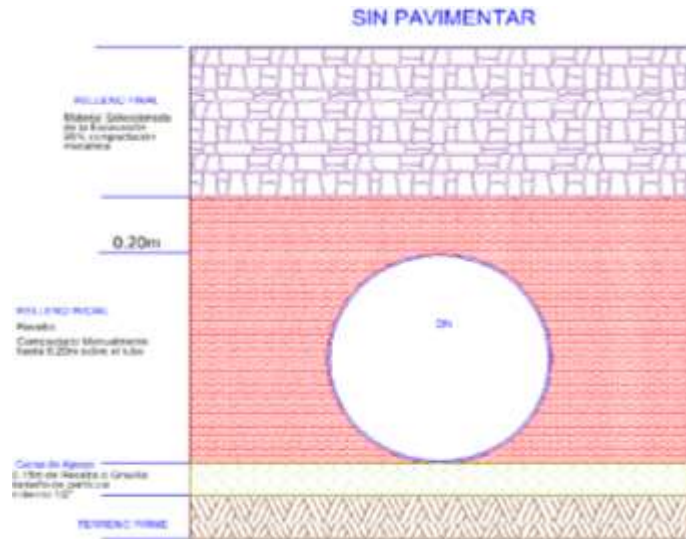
Instalación De Redes De Alcantarillado En Vía Sin Pavimento
